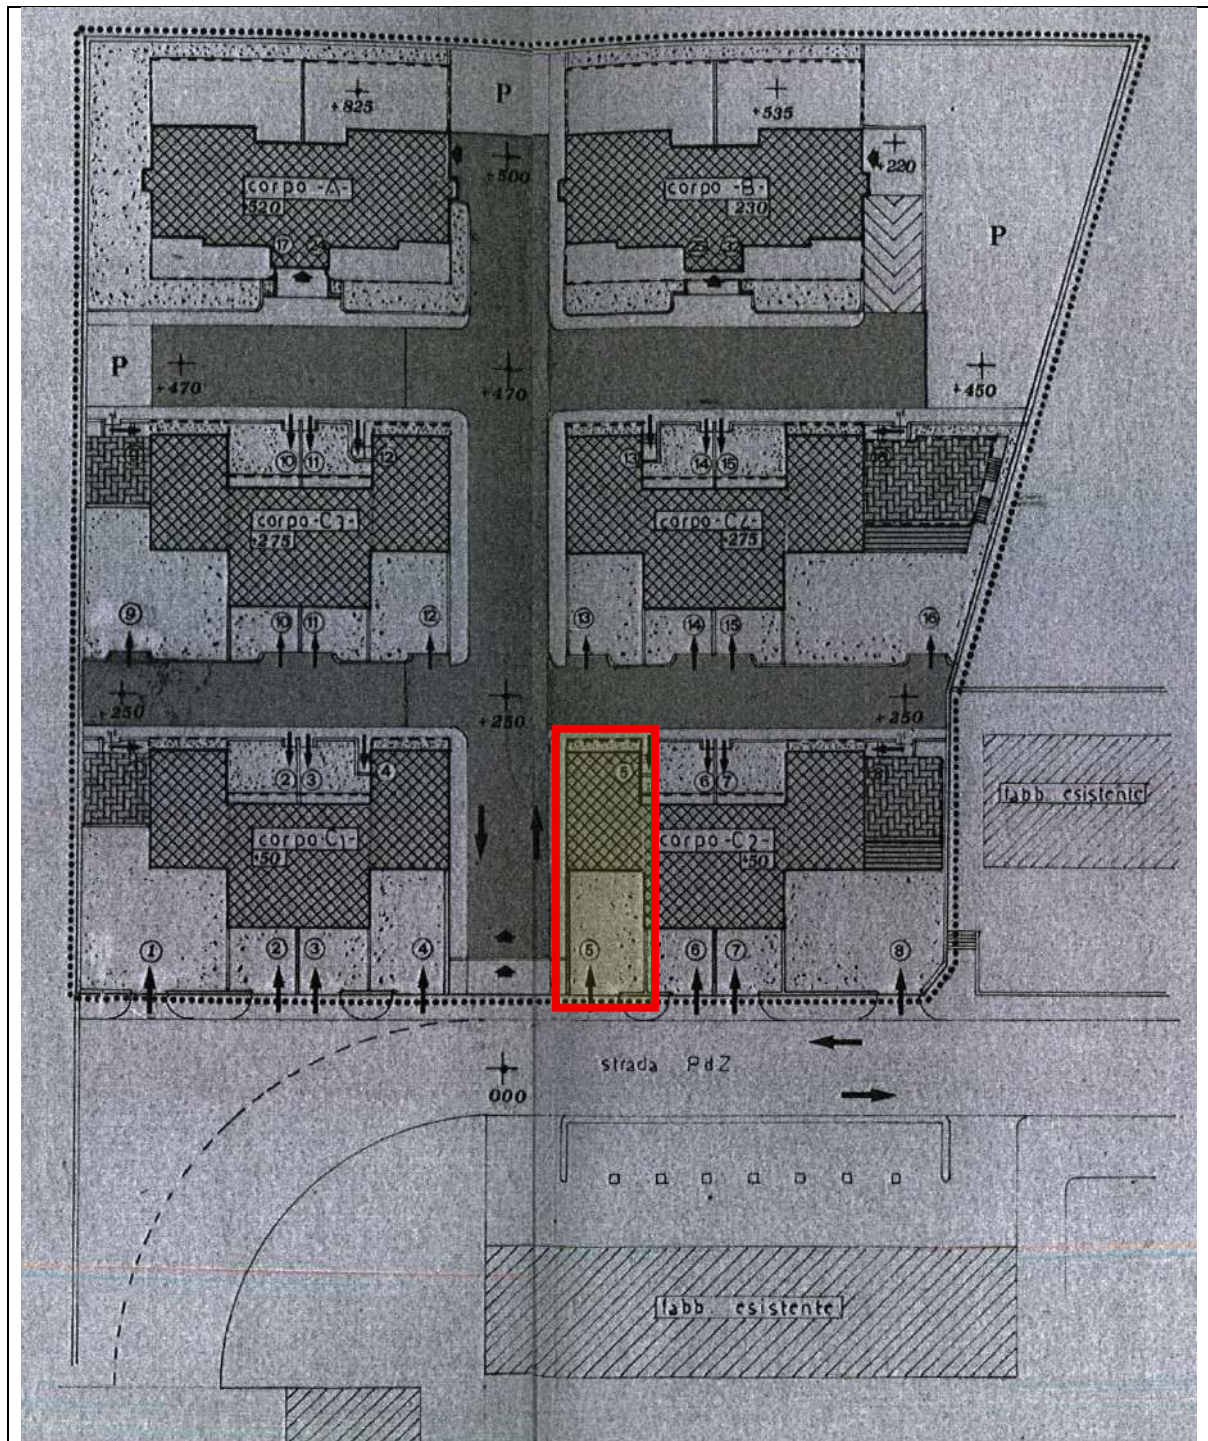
Estratto della planimetria generale dagli atti di progetto rinvenuti presso l'UTC di Avellino – individuazione del "bene 1" – in figura sono individuate con fondo grigio le aree di viabilità interna al parco
